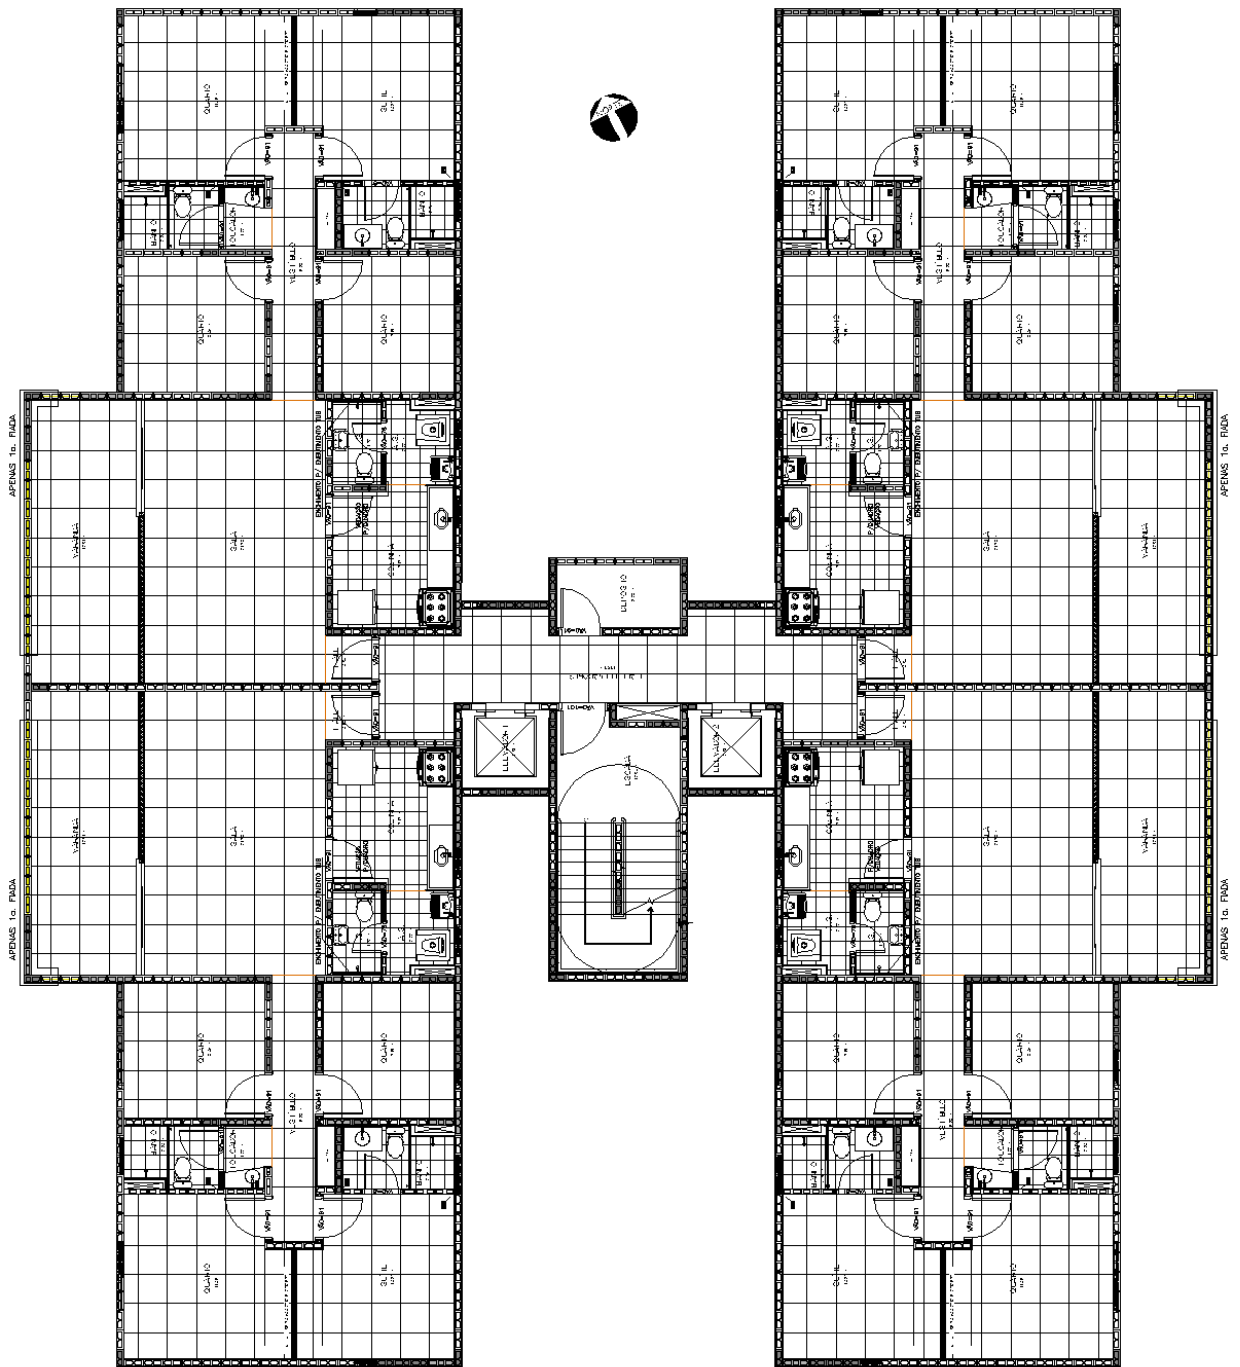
Pavimento tipo torre quatro quartos - adequado
